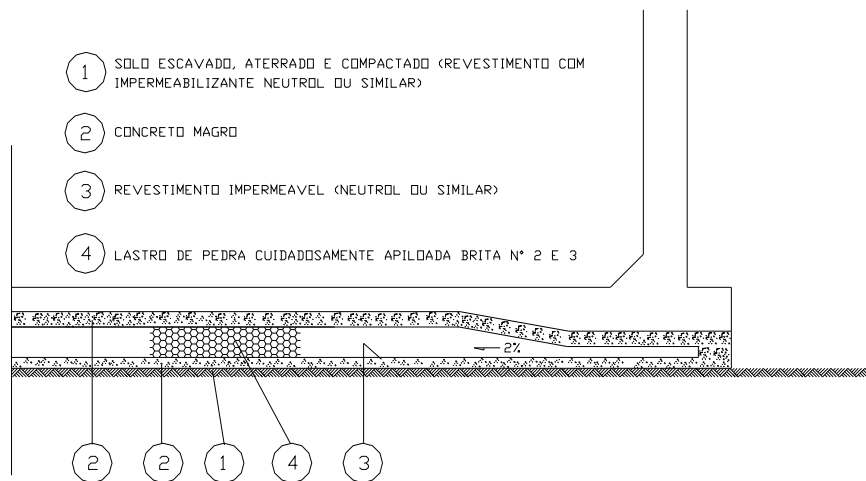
Detalhe do fundo de reservatório de concreto armado
